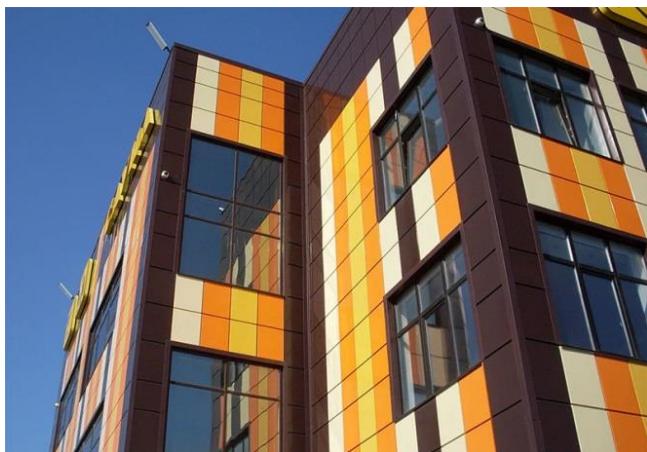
Фасад здания, выполненный по технологии вентилируемого фасада
